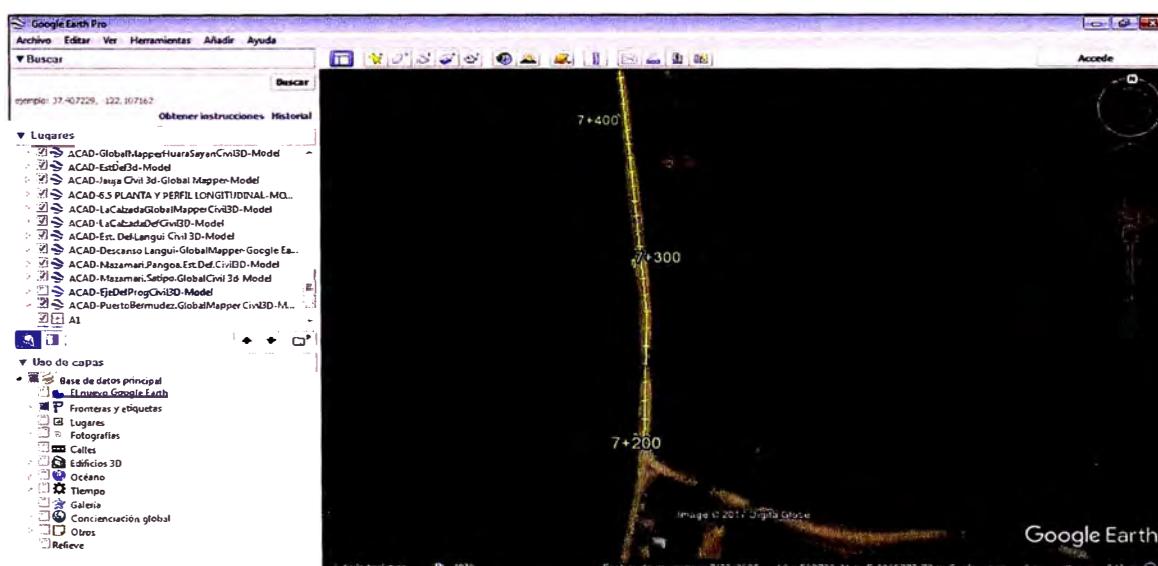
Trazado en planta Eje procedente del Estudio Definitivo para la Rehabilitación Mejoramiento de la Carretera Puerto Bermúdez Ciudad Constitución Tramo Desvío Puerto Bermúdez-San Alejandro. Fuente: Elaboración propia.
